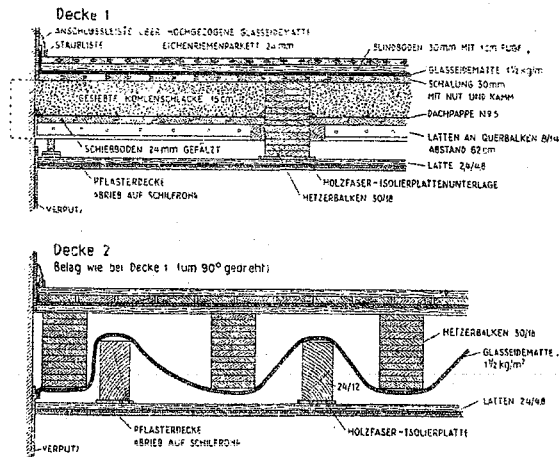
Holzdecken für Schulhäuser. Querschnitt der beiden besten Holzdecken. Schwere Decke mit 295 kg/m<sup>2</sup> und Doppeldecke mit 135 kg/m<sup>2</sup>. S. B. Z.
